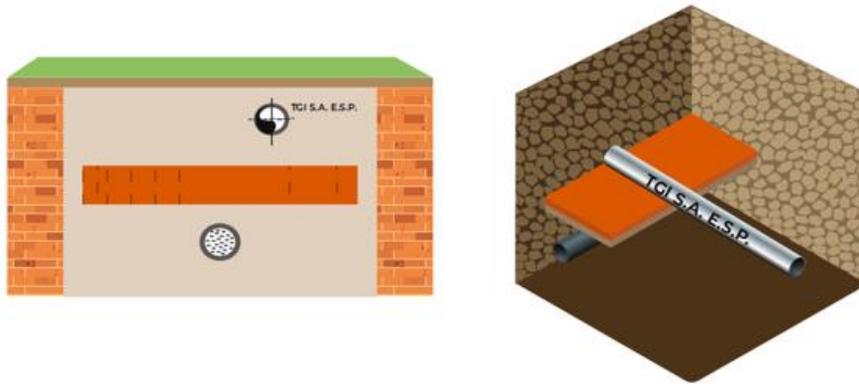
Protección con ladrillos más planchas de caucho sintético o placas de PRFV-cruce.
